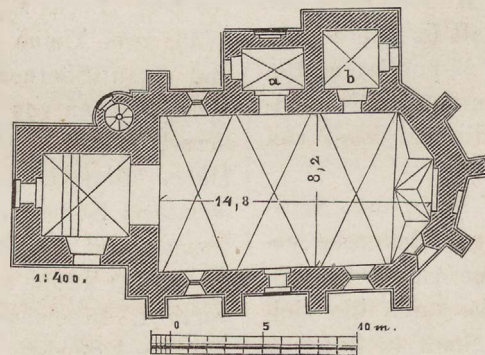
Marzdorf. Grundriss der kath. Kirche.
